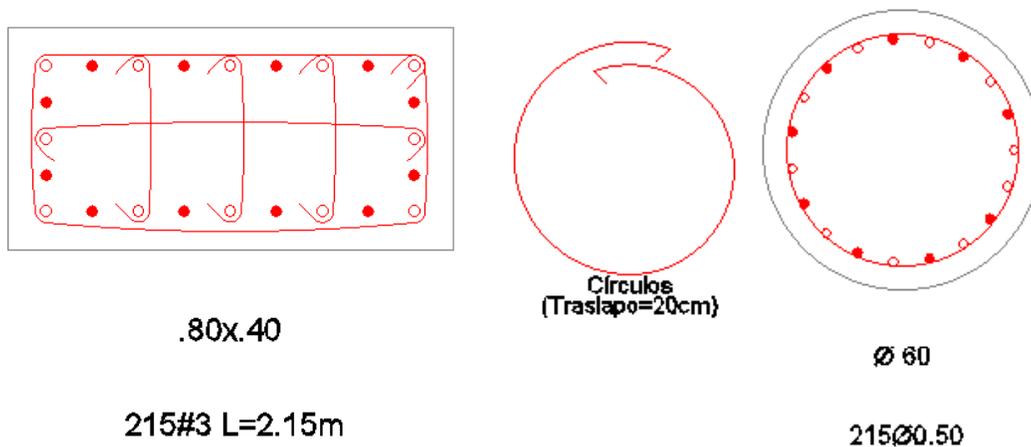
Ejemplo de detalle de acero longitudinal y transversal de columnas.
